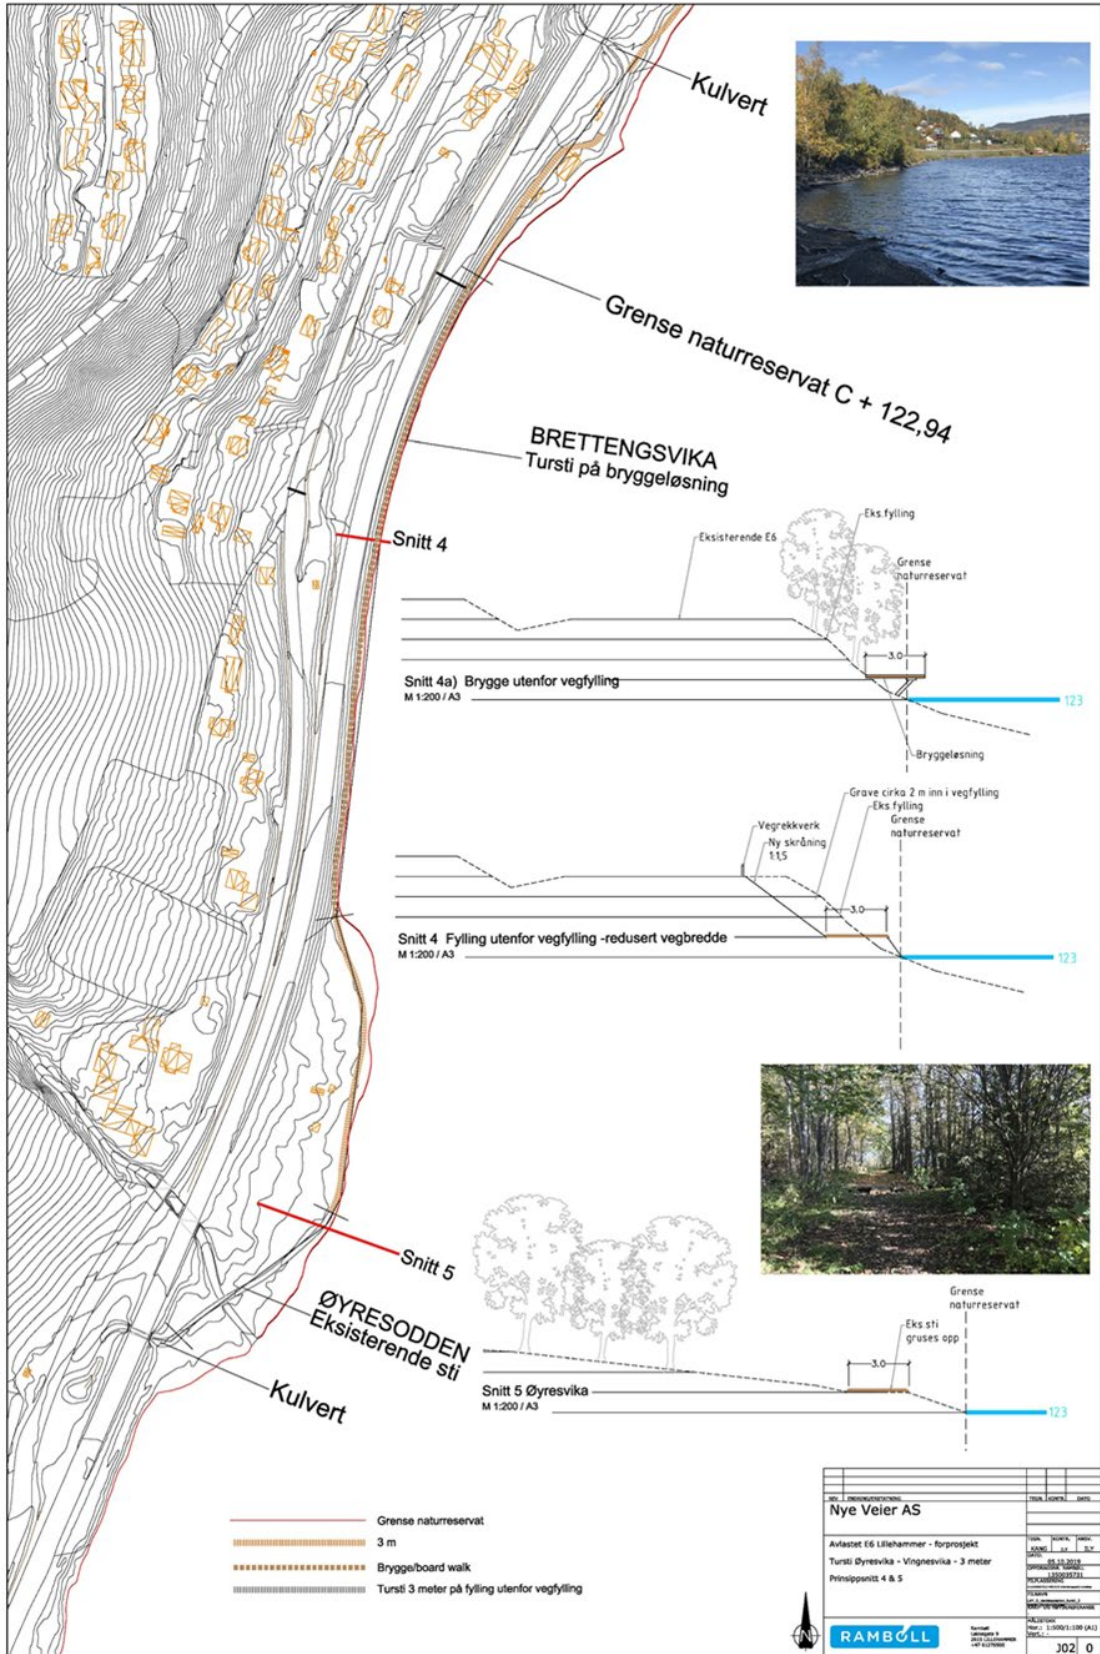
Her ligger det til rette for oppgradering av eksisterende sti. Bildet til høyre viser klopp over bekk
